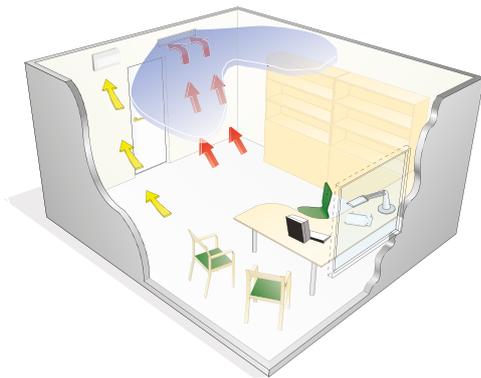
Luftverteilung mit Paragon WALL in einem Einzelbüro
